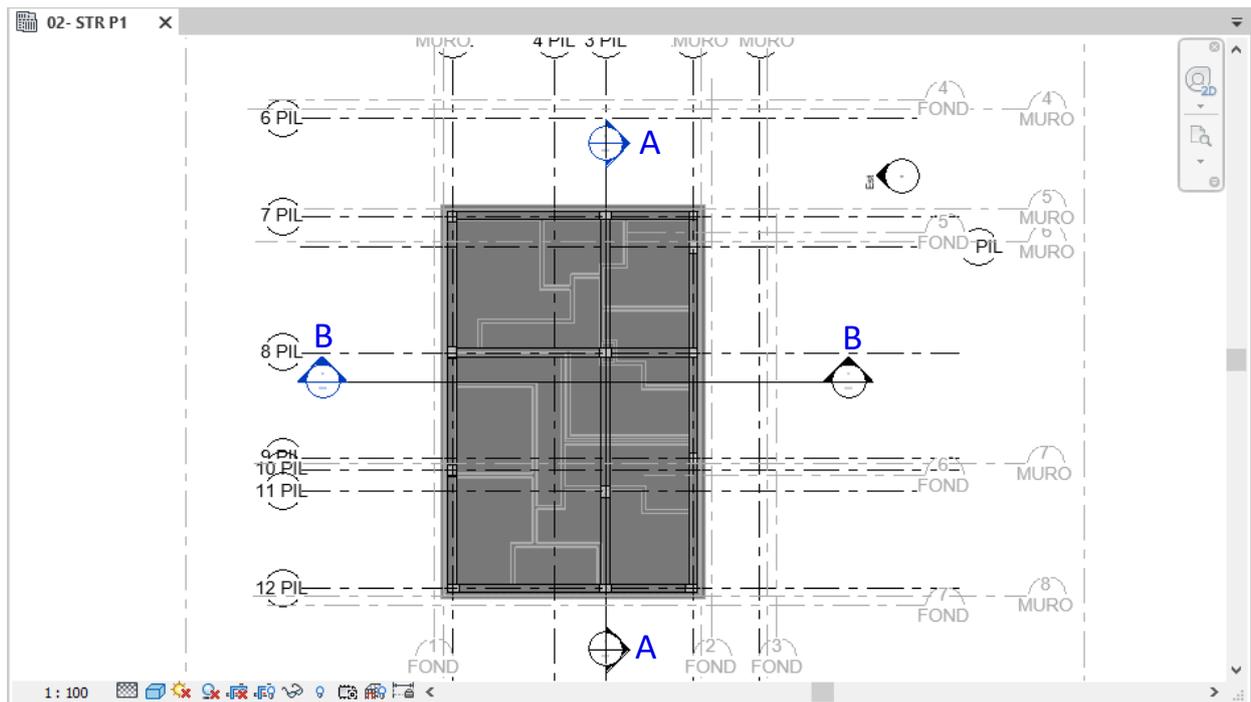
Vista 02-STR P1: Pianta strutturale piano primo modello strutturale
